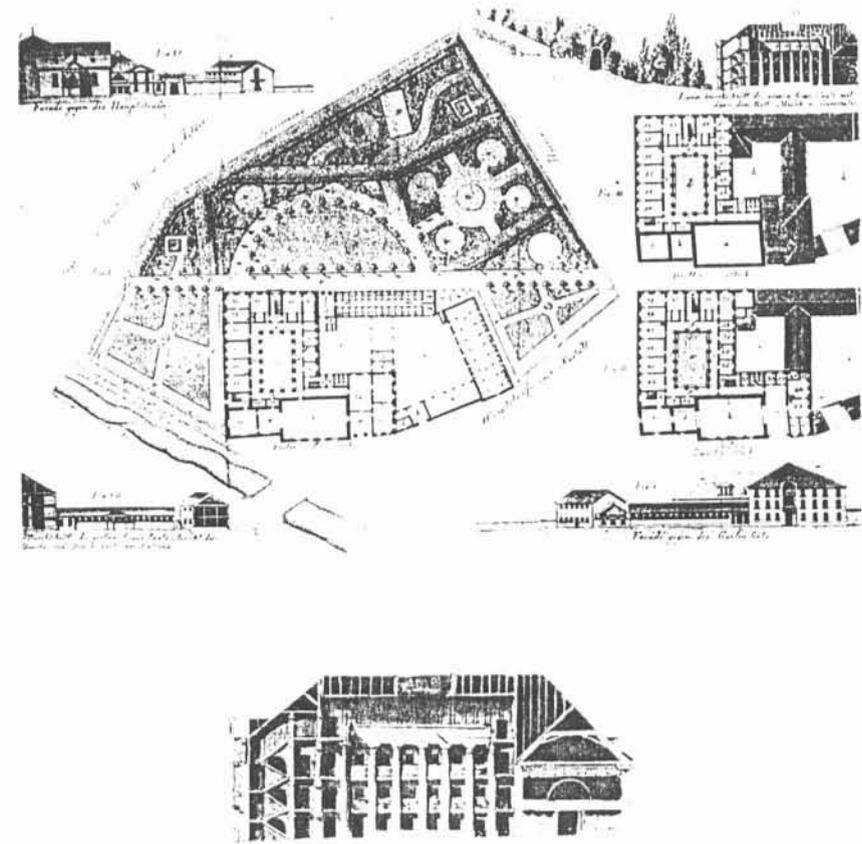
e 3. Drei Mohren, I. Gunezrainer, Augsburg, 1722. Fachada e plantas baixas.
